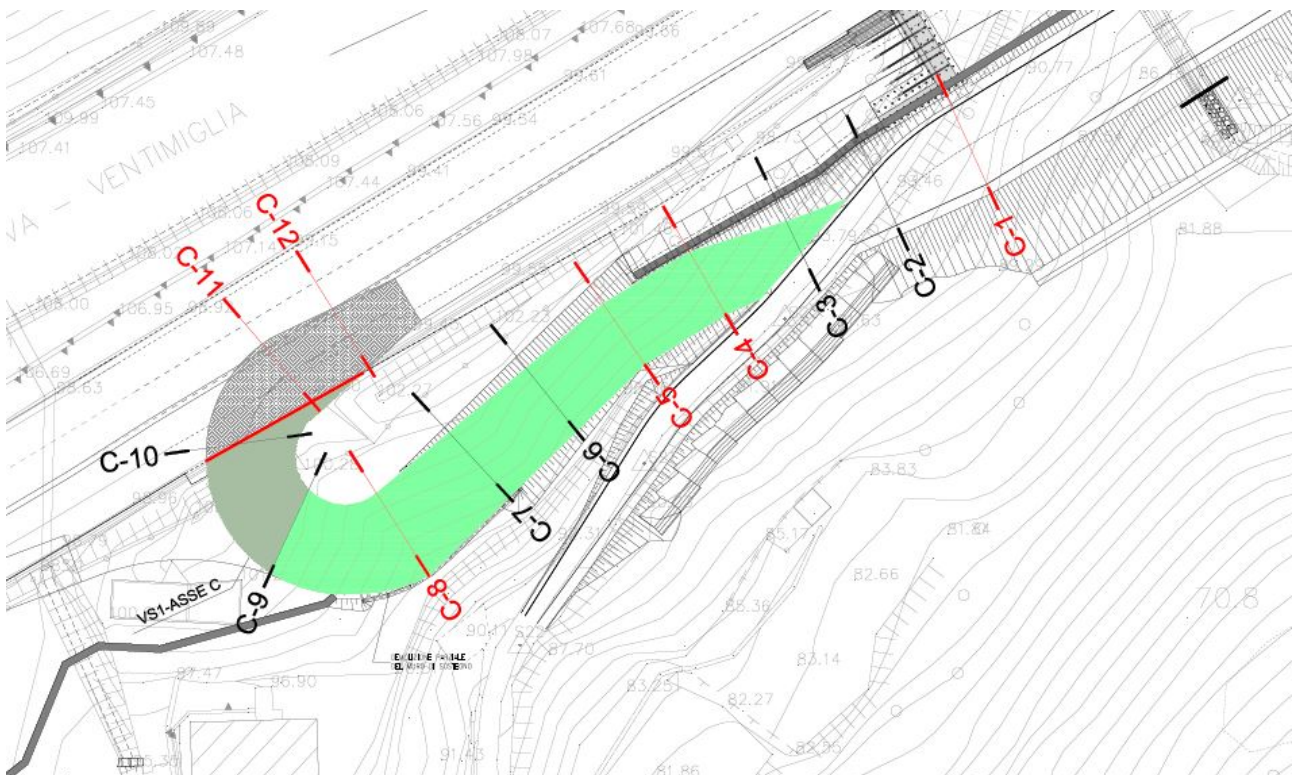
Planimetria VS001C con indicate le linee di sezione di riferimento
